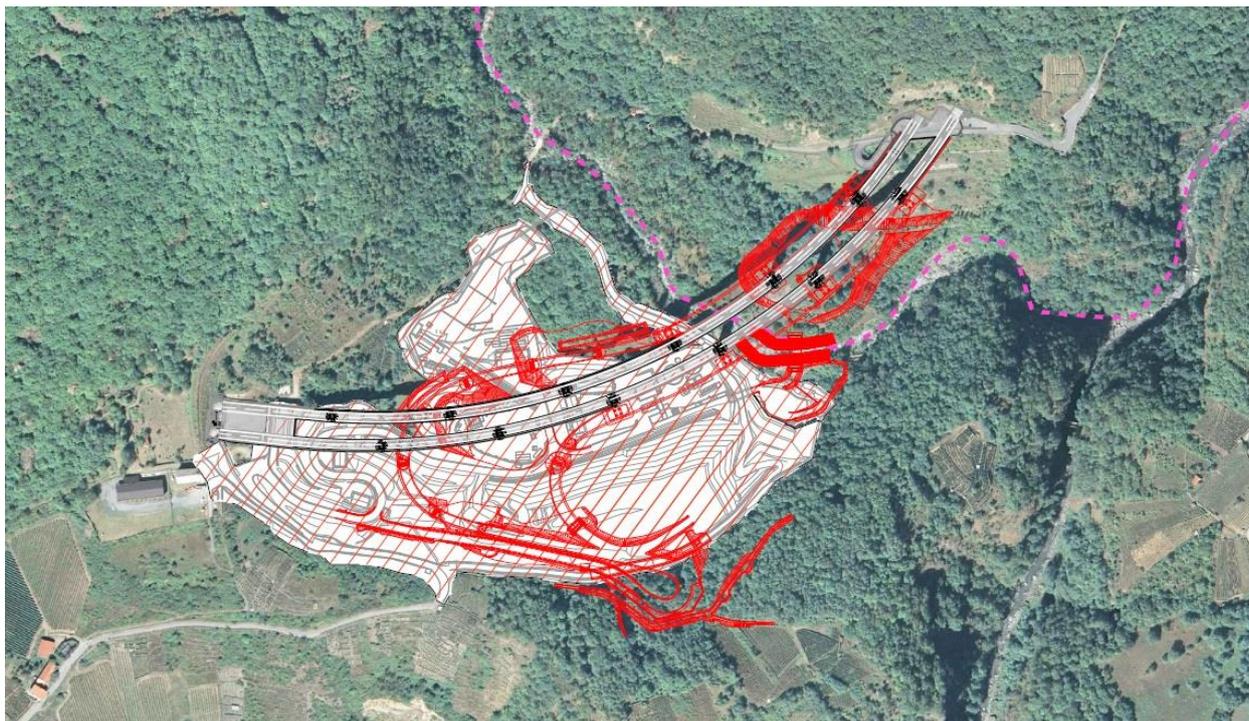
Planimetria progetto Esecutivo (in rosso)
